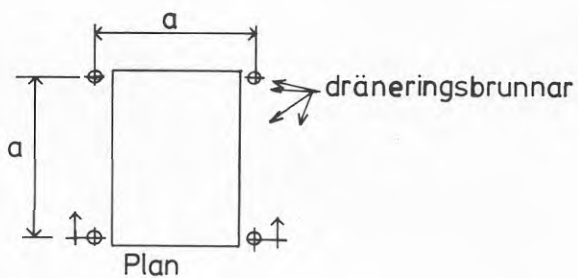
Grundvattenyta mellan dräneringsbrunnar.
